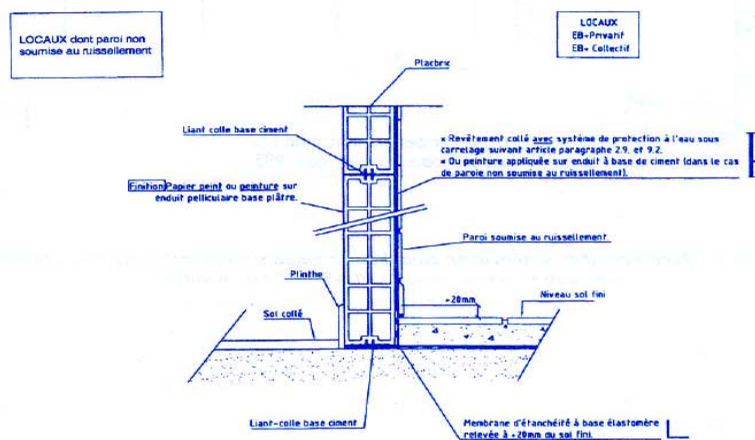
a – Disposition en pied – Cas d'une paroi soumise au ruissellement sur une face et non sur l'autre
